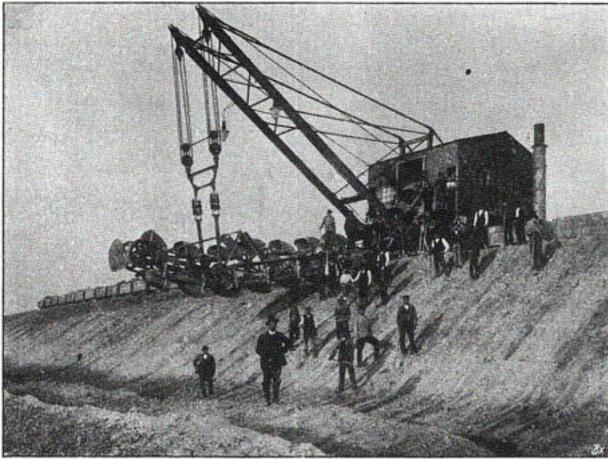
Lübecker Maschinenbaugesellschaft, Lübeck.
